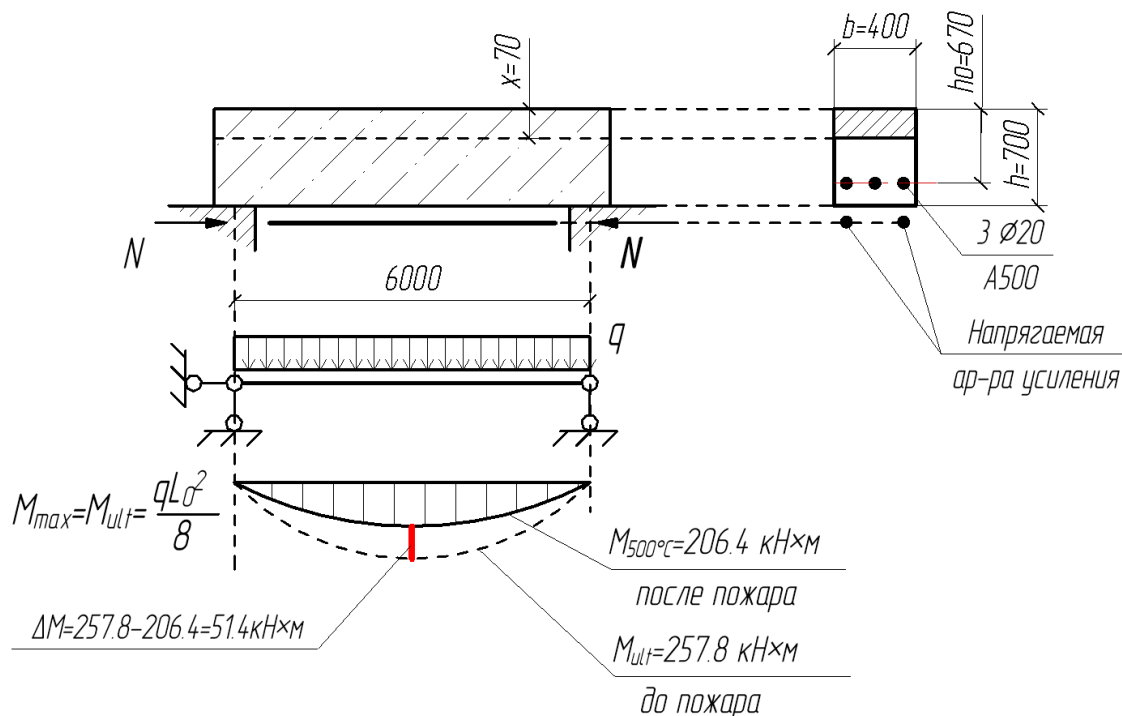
Расчетная схема ж.б. балки и её поперечного сечения
